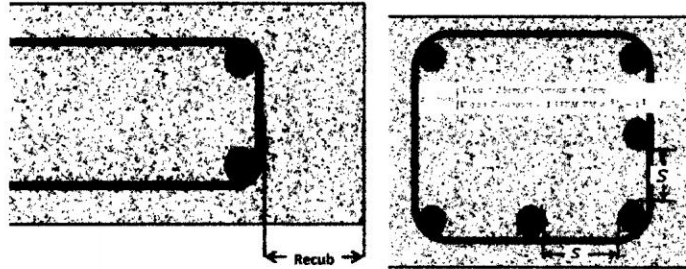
Recubrimiento mínimo y espaciamiento de refuerzo longitudinal de acero
